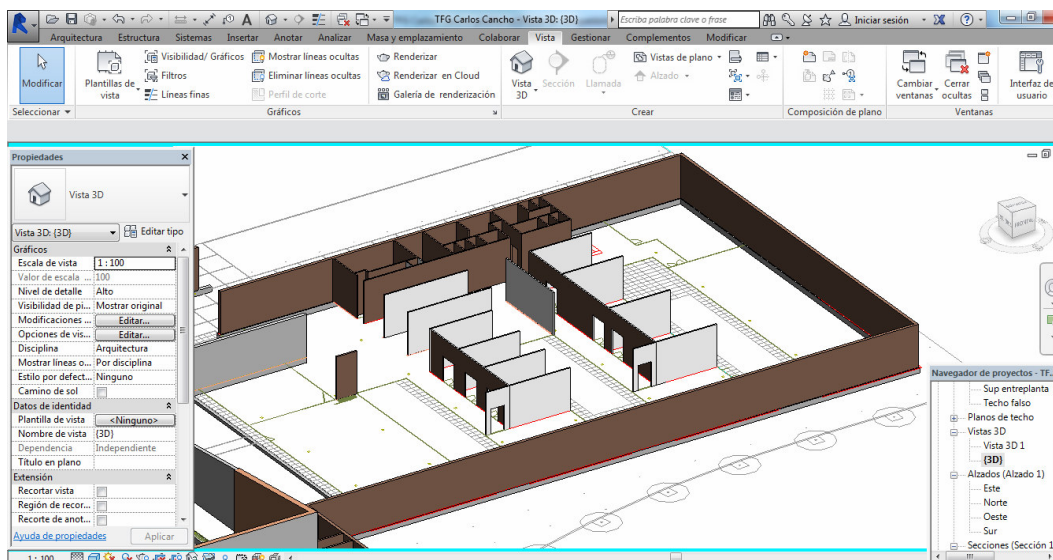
Detalle del plano utilizado como plantilla junto a los muros construidos a partir de él.
